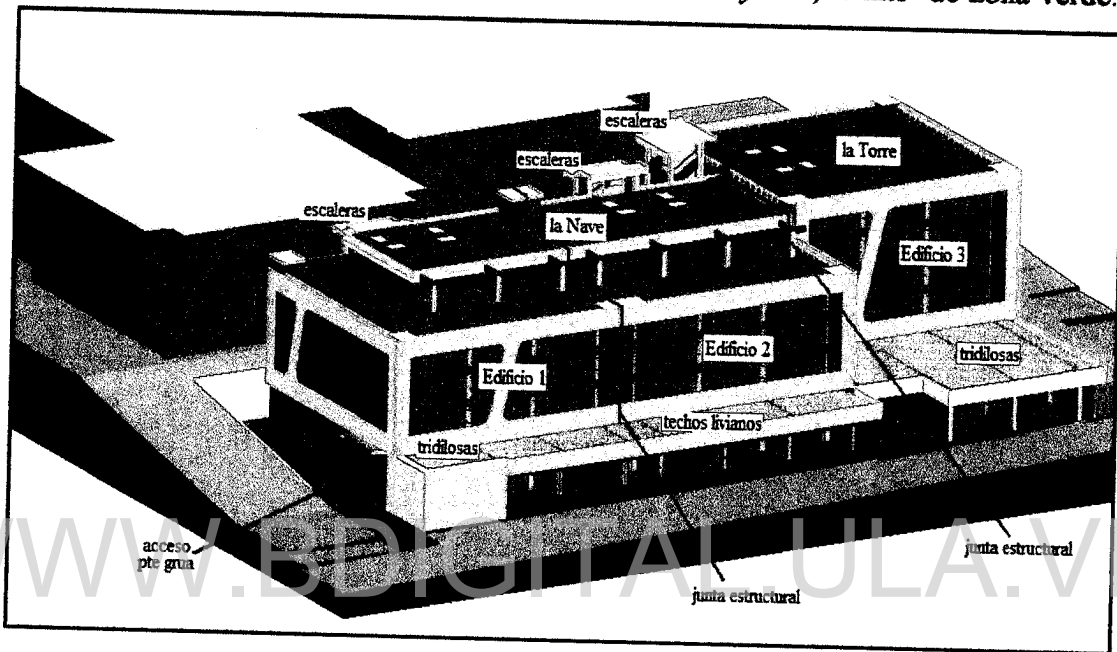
, Planteamiento arquitectónico, fachada principal.
